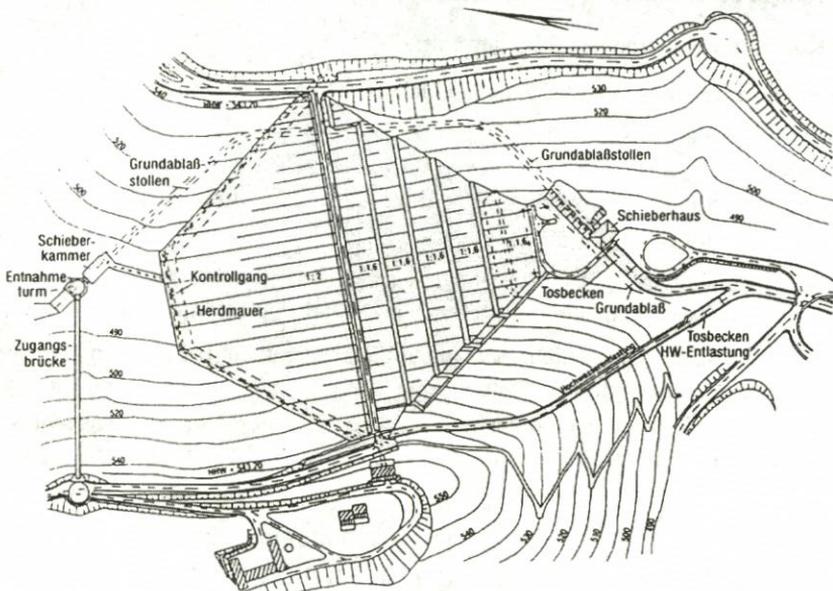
Talsperre Schönbrunn (Lageplan des Steinschüttdammes)
